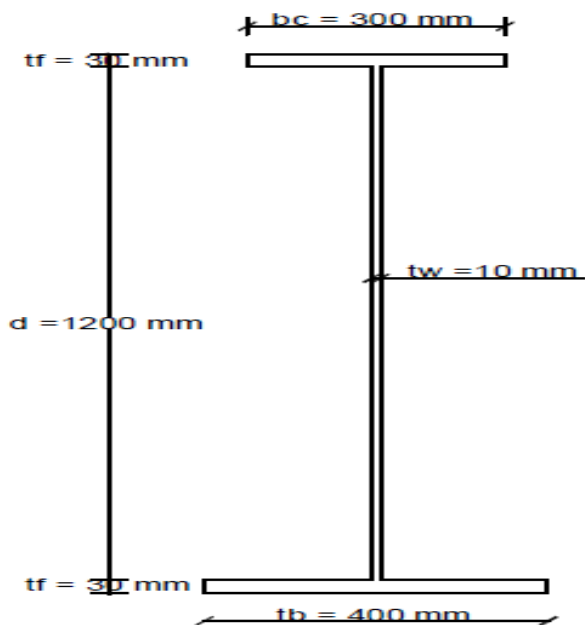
Viga metálica definida su sección. Elaborado por: Autor
